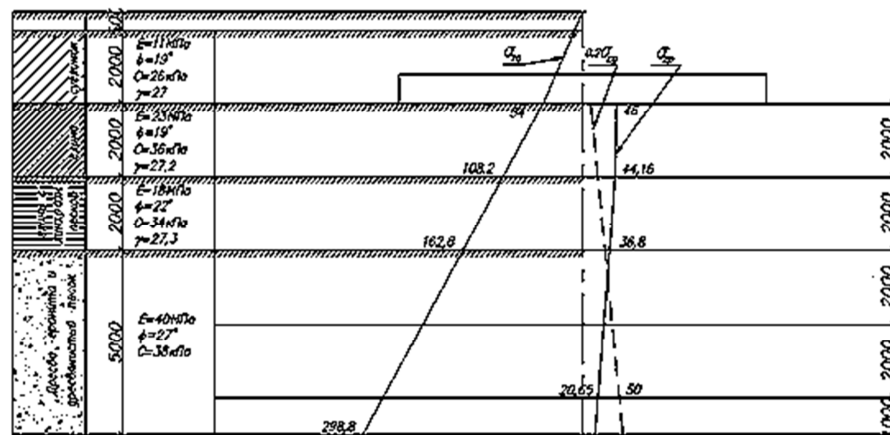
Схема распределения напряжений ниже подошвы фундамента  $\sigma_{zg,i}$  – от собственного веса грунта и от нагрузки сооружением –  $\sigma_{zp,i}$
